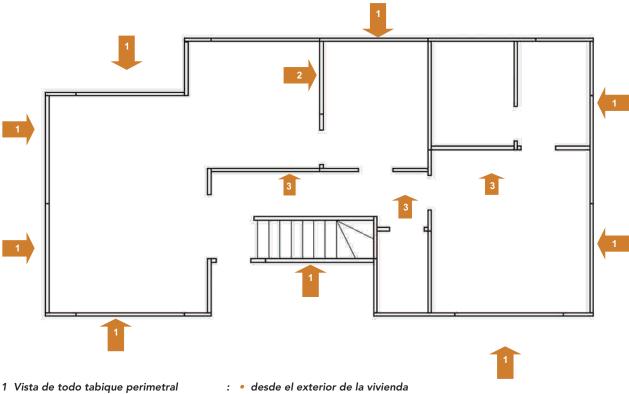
64: Plano planta de arquitectura del primer piso con distribución de recintos.
